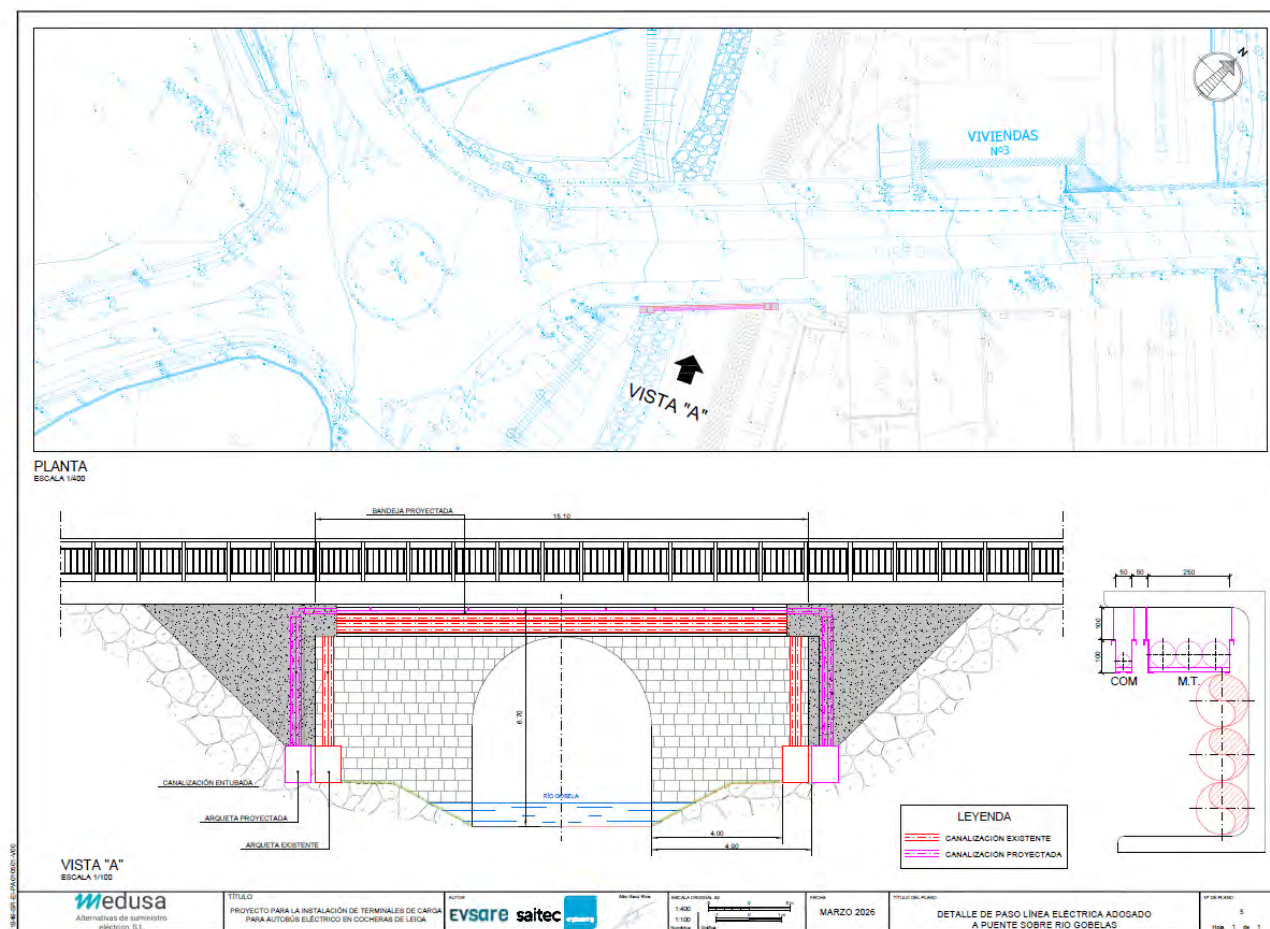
Plano detalle paso línea eléctrica adosada a puente sobre río Gobela
